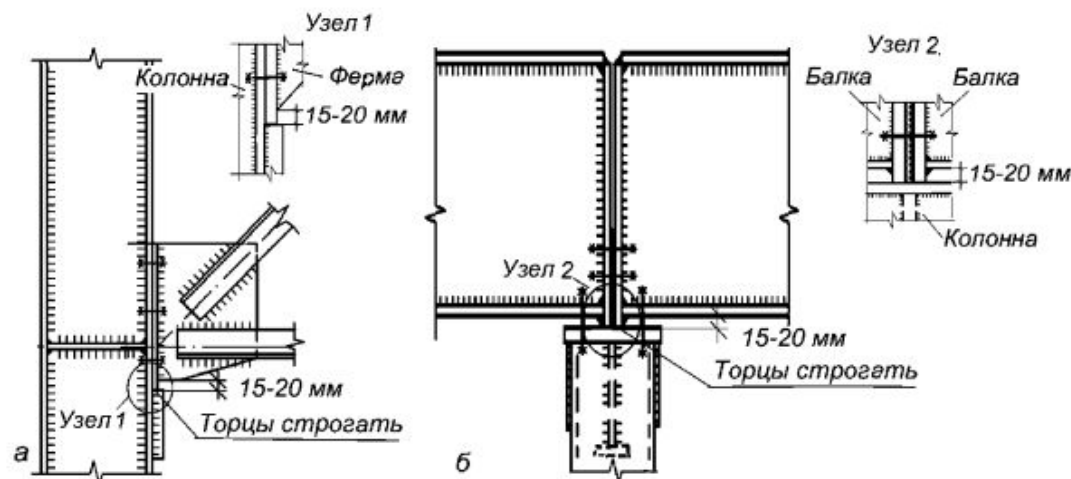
Опорные узлы: а – фермы; б – балки
